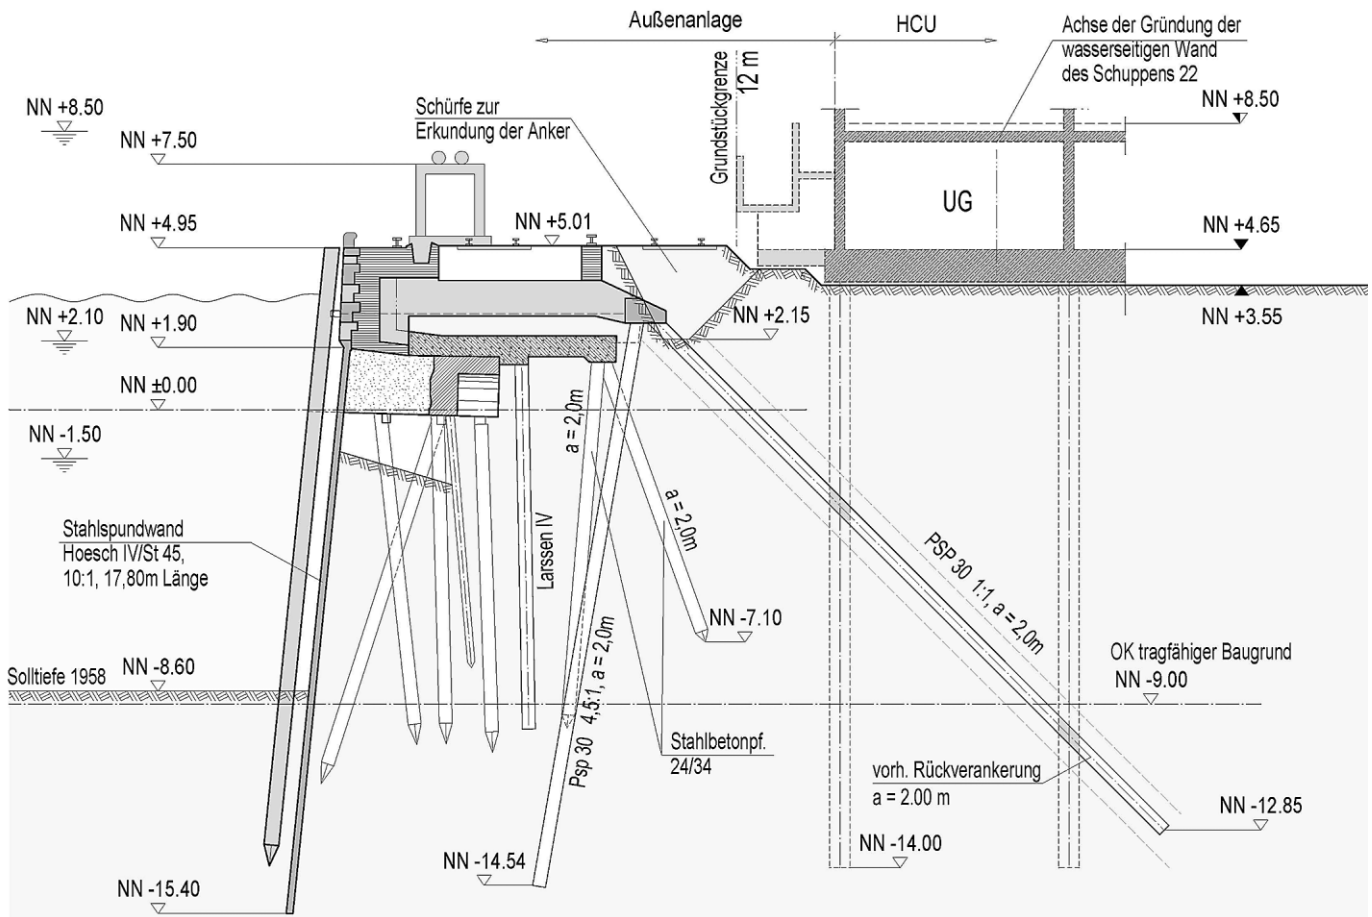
Kaimauerkonstruktion Regelschnitt 2 mit Rückverankerung PSP-Profil
